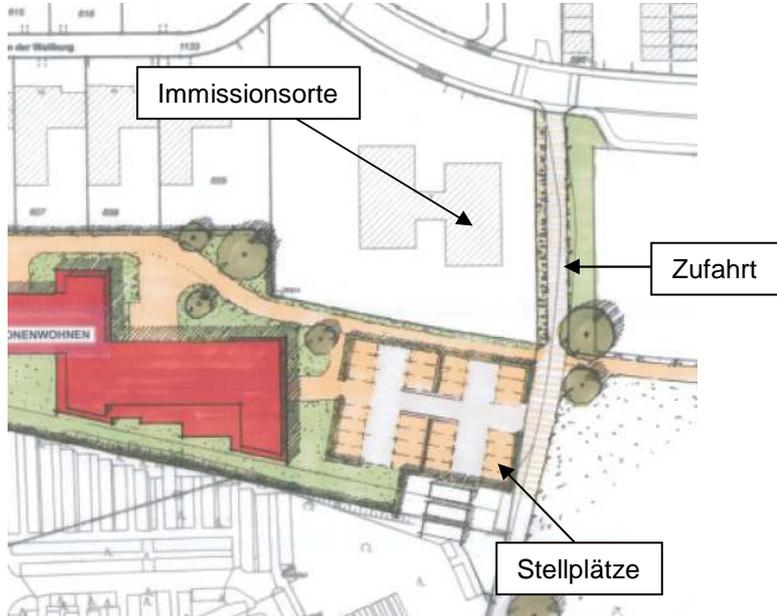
voraussichtliche Lage der zukünftigen Zufahrt zum Baugebiet WR 1 sowie der privaten Stellplätze
